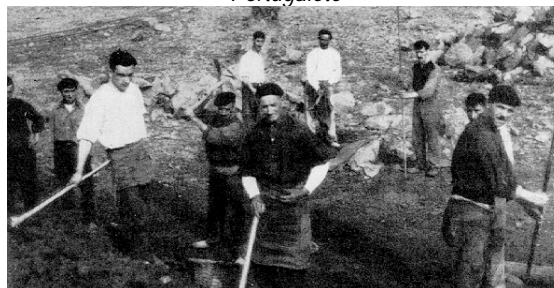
Obras de construcción de una de las viviendas del Porvenir, Baracaldo
